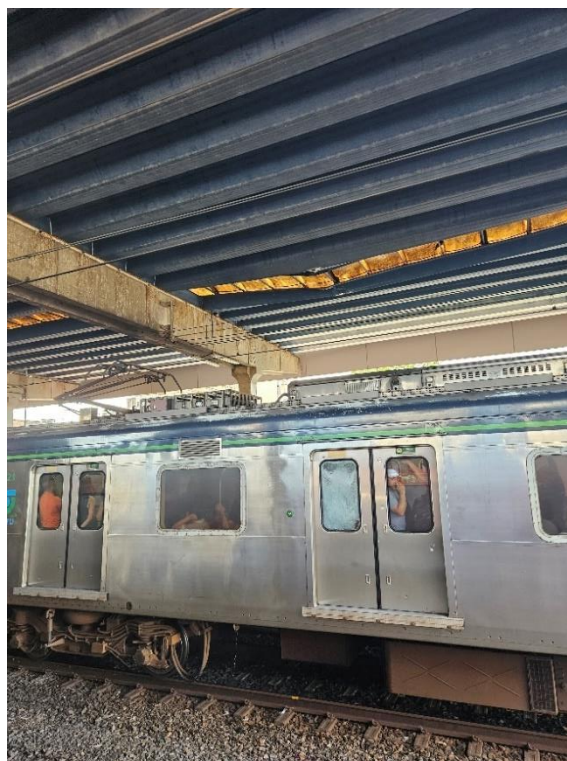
Falta um trecho da cobertura, telhas e Domus danificados, infiltrações
